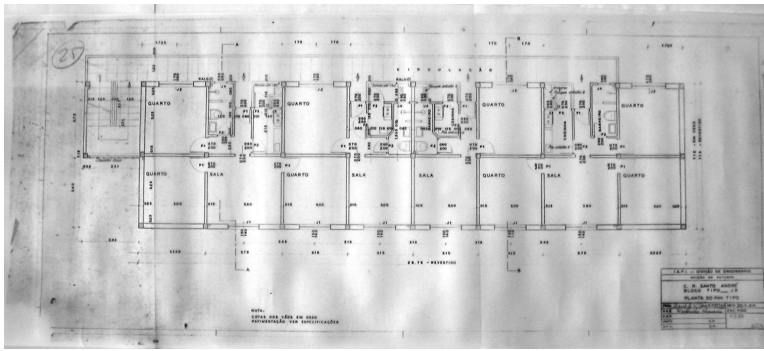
Planta do pavimento tipo do edifício com tipologias J1 e J2. Fonte: arquivo INSS.
